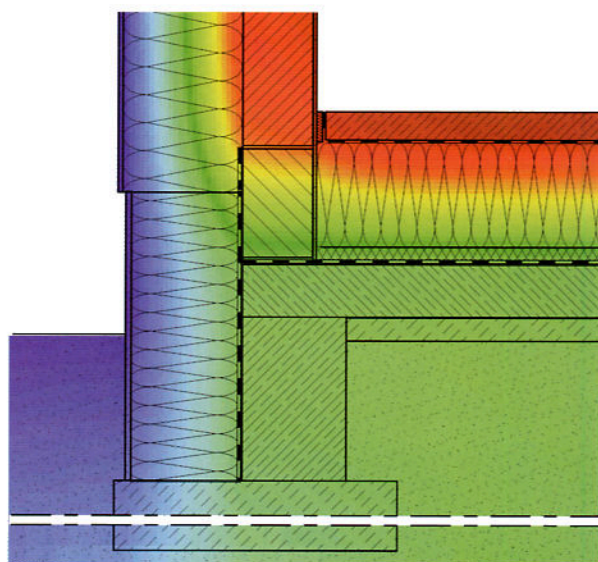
Flux thermique : coupe du fondement et du plancher isolé à l'intérieur
